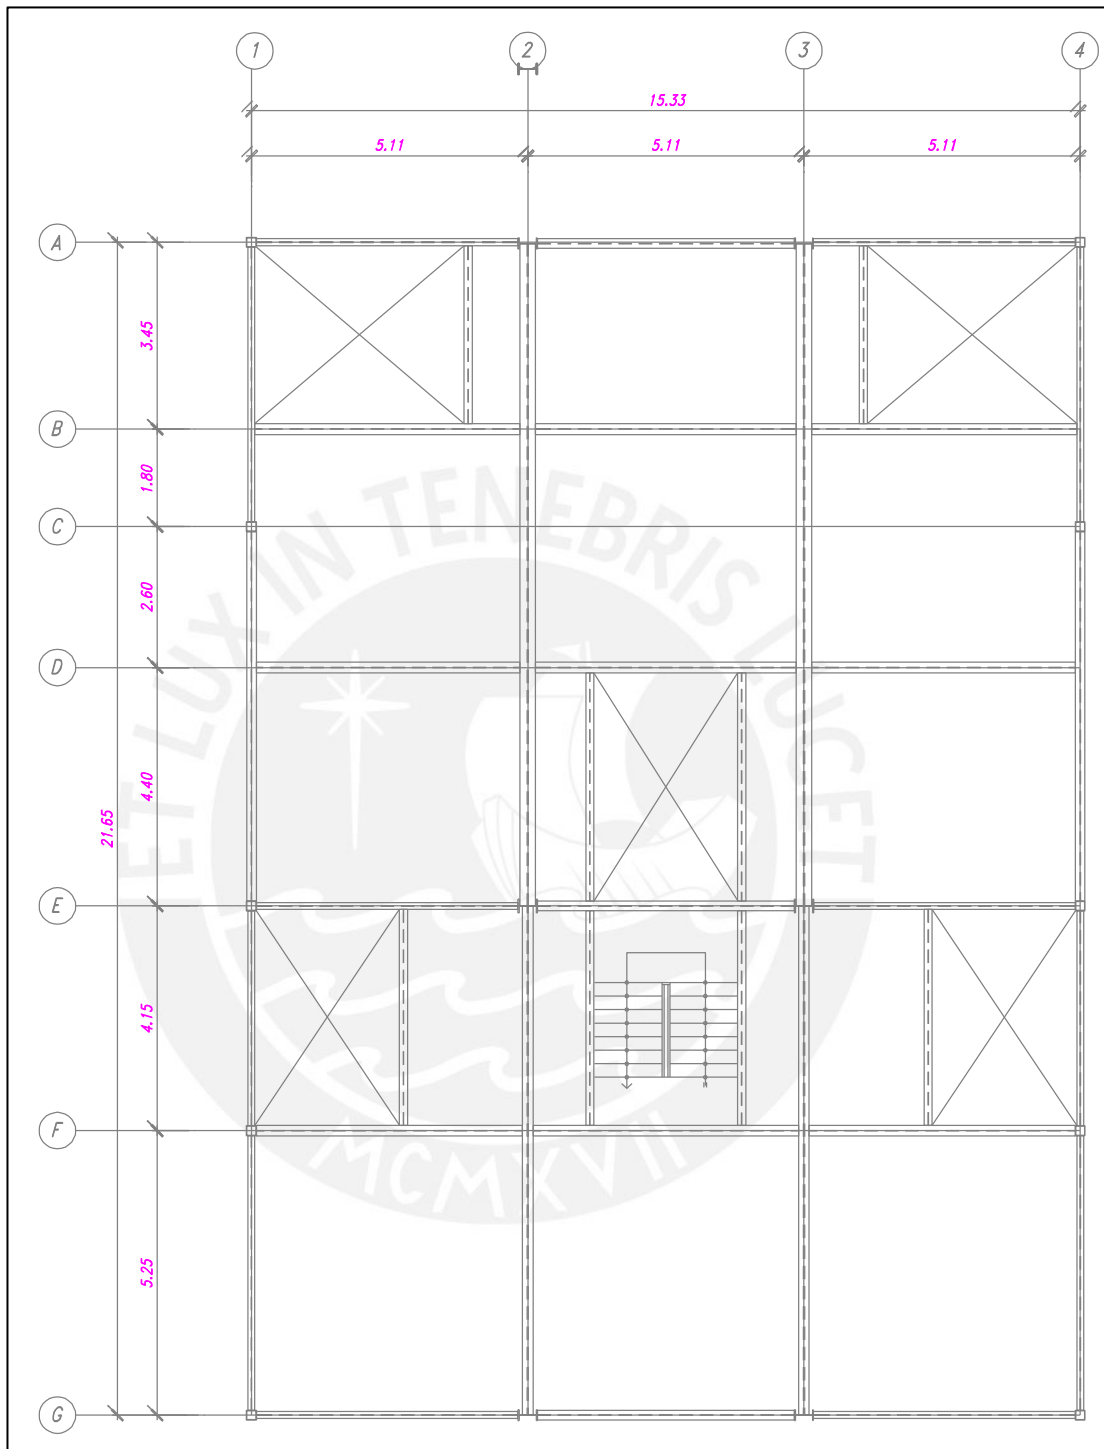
Vista en Planta de la posición de columnas y vigas
